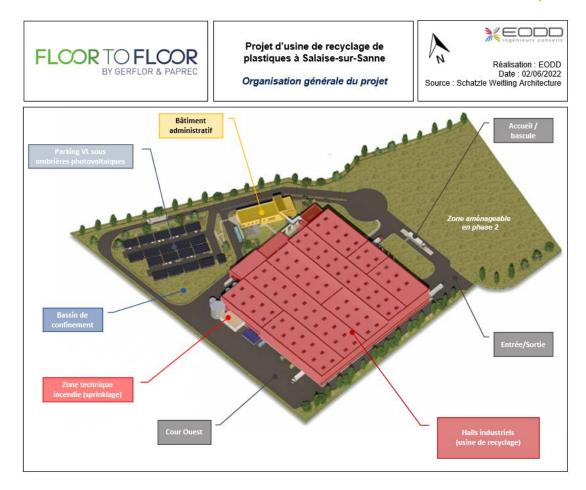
Plan d'organisation générale du projet Floor to Floor (vue axonométrique)
